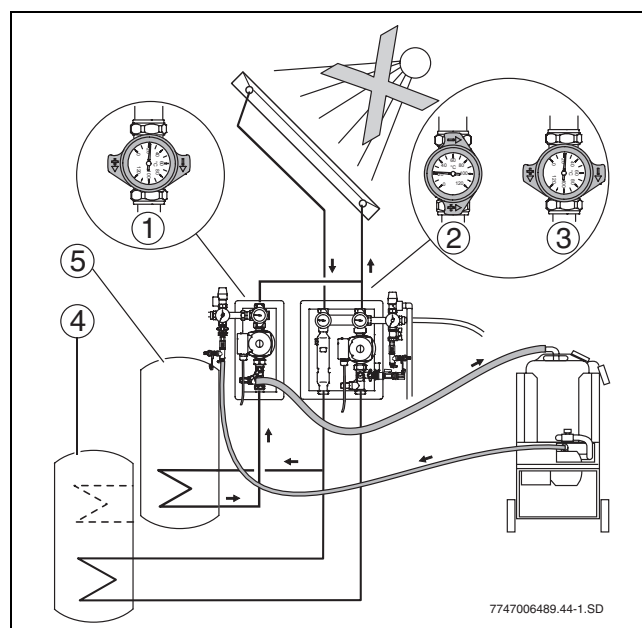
Промывка установок с двумя потребителями и двумя насосами - здесь: промывка бойлера 2
